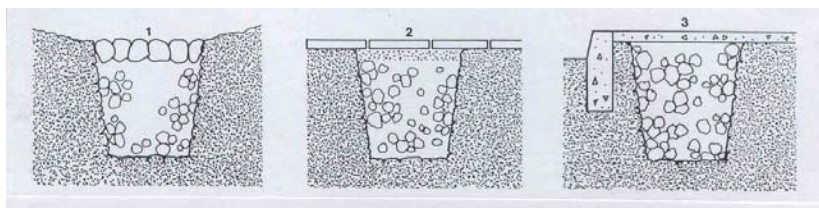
Alternativa de cubierta. 1.- Piedras o rocas permeables, 2.- Pastelones o adoquines, 3.- Veredas o losas.
